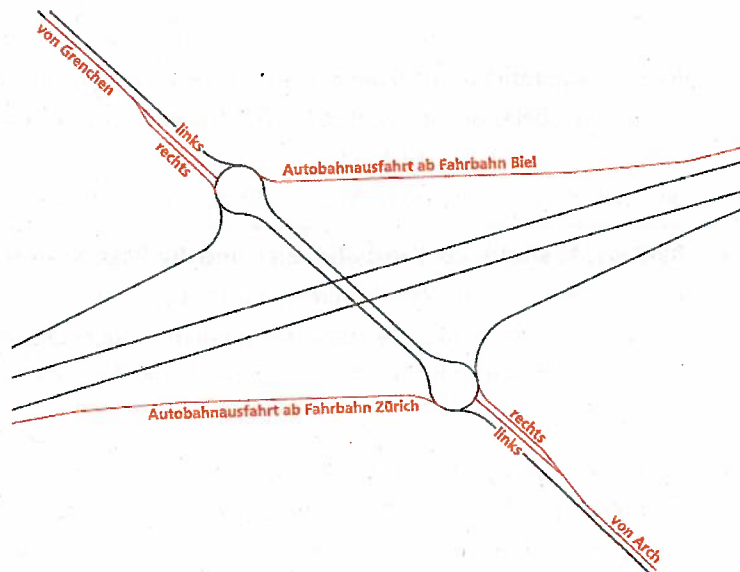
Beschriftung Zufahrten Anschluss Grenchen
